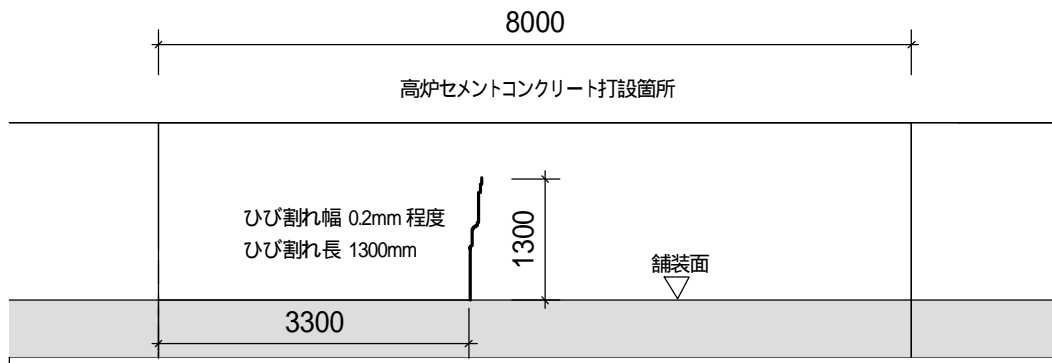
高炉セメントコンクリート打設箇所に発生した乾燥収縮ひび割れ
